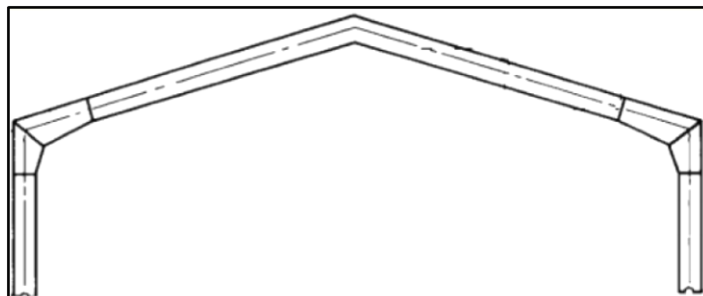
Vista en elevación galpón con pórticos rígidos. [Gaylord et al., 1990]
